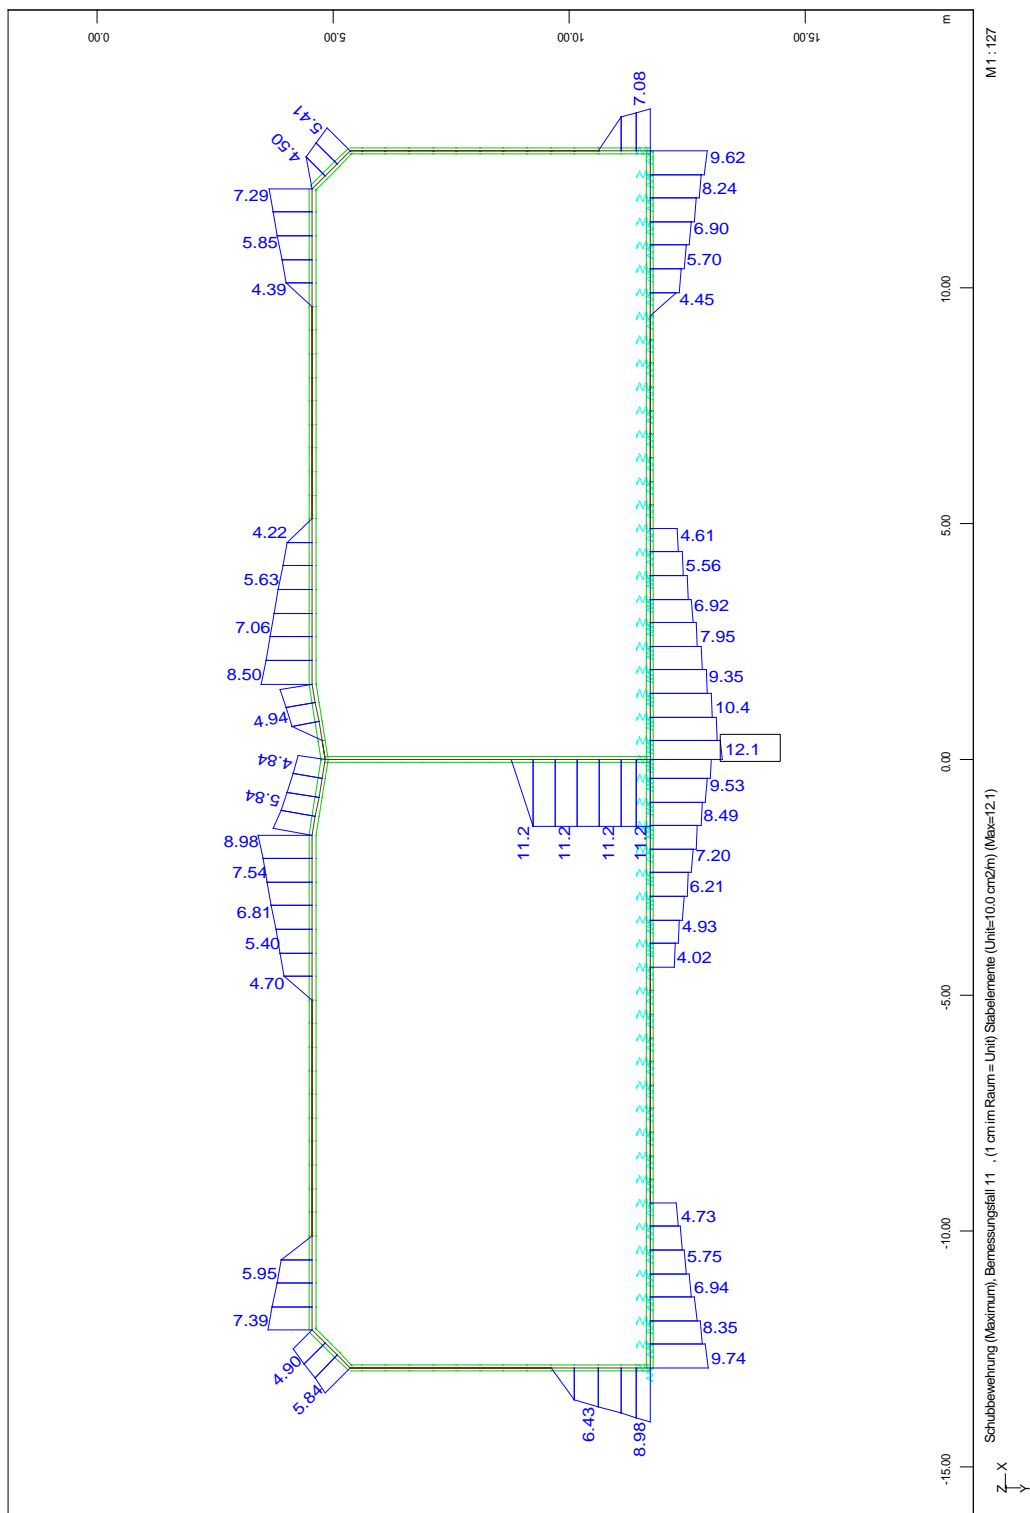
Schubbewehrung, außergewöhnliche Bemessungssituation
